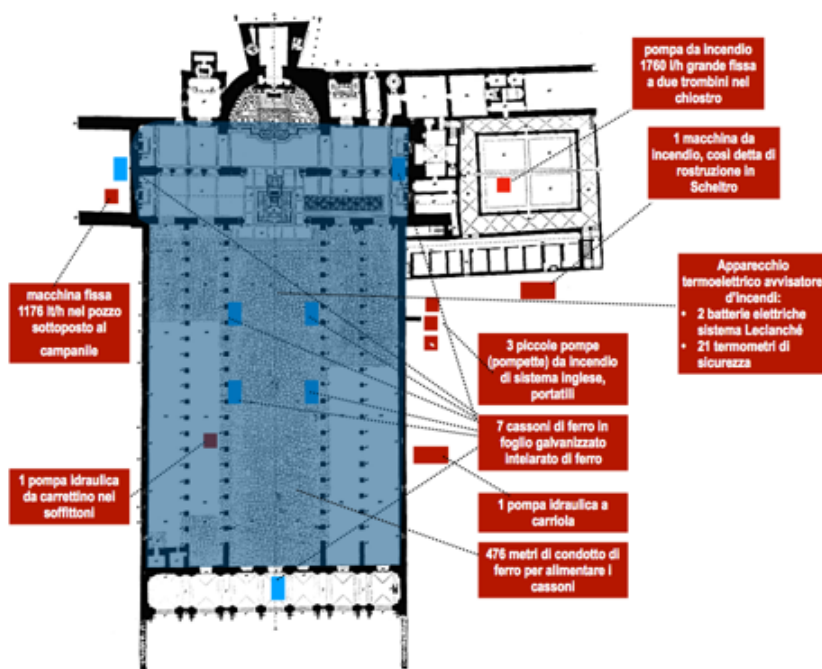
Schema indicante la posizione ipotetica degli apparati di protezione installati nella basilica su progetto di Padre Secchi e Giacomo Luswergh.
